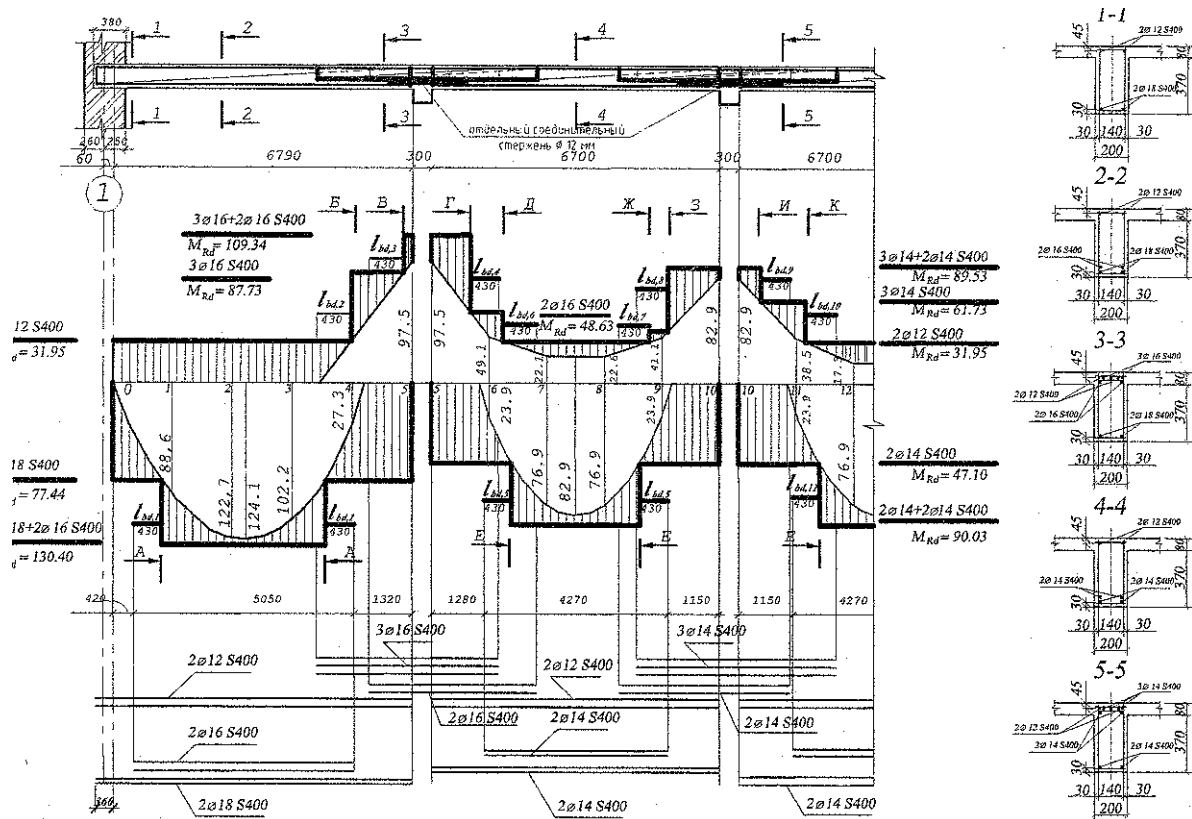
Эюра материалов второстепенной балки для варианта армирования отдельными стержнями
